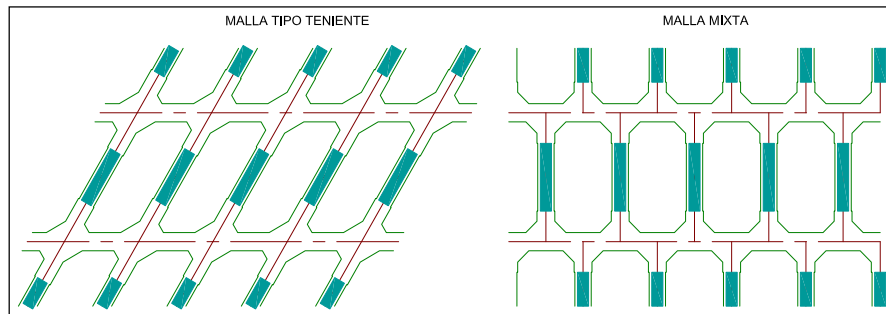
Excavaciones Sección 4,4 x 4,3 [mxm]
